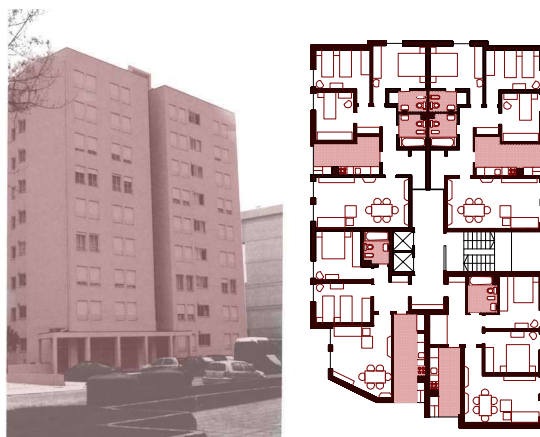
Prémio INH 2002 - fotografia e planta habitação tipo
